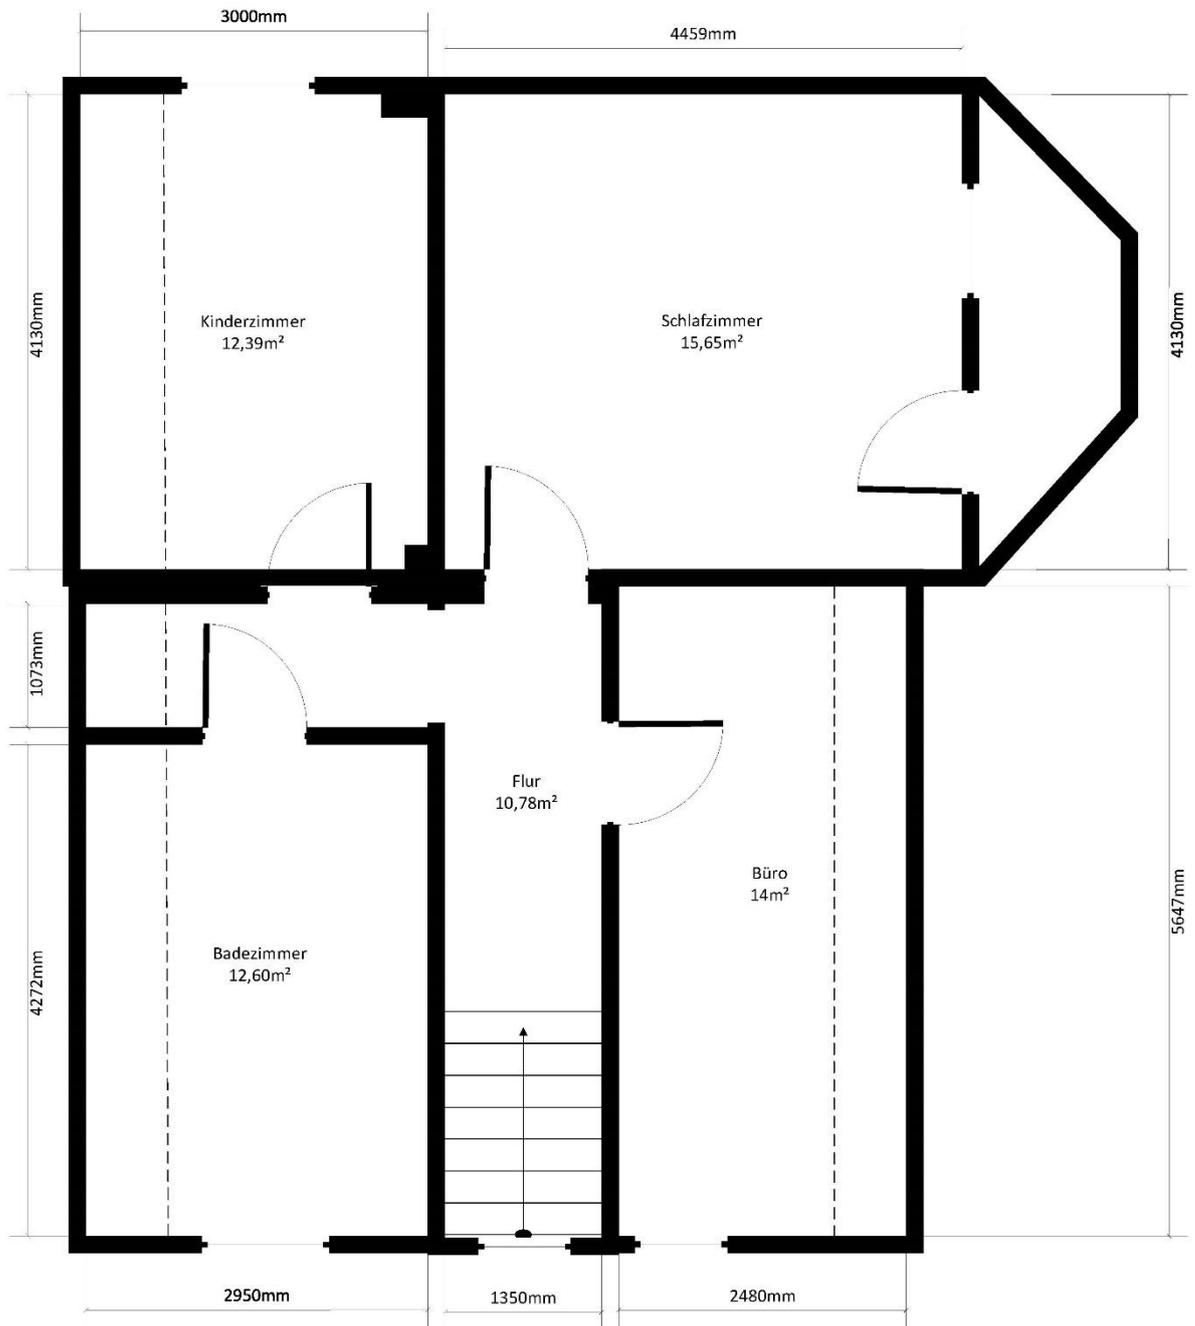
Aktuelle Übersicht der Grundrisse im Obergeschoß
